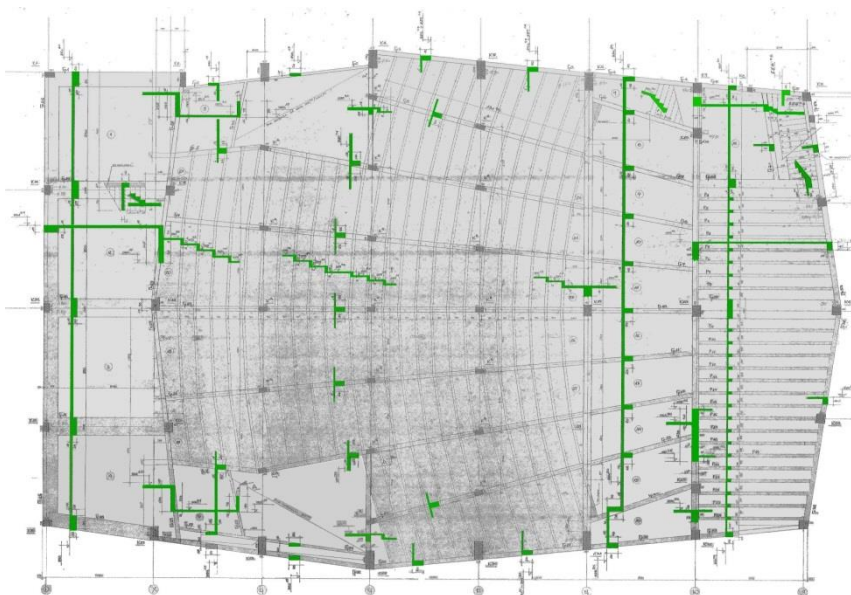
Котражен план на основи – блок 8 на УАСГ
